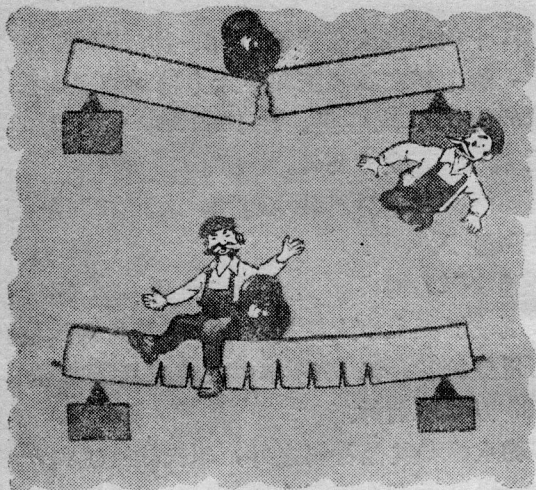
配筋的鋼筋混凝土能承受的荷重，比不配筋的要大得多。在混凝土中出現裂縫之后，全部拉力由鋼筋來承受。
